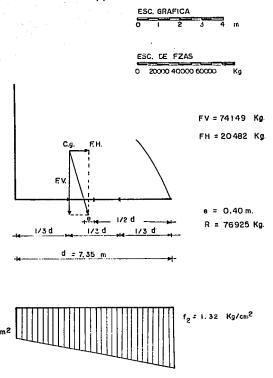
ESFUERZOS EN LA CIMENTACION DE LA CORTINA
